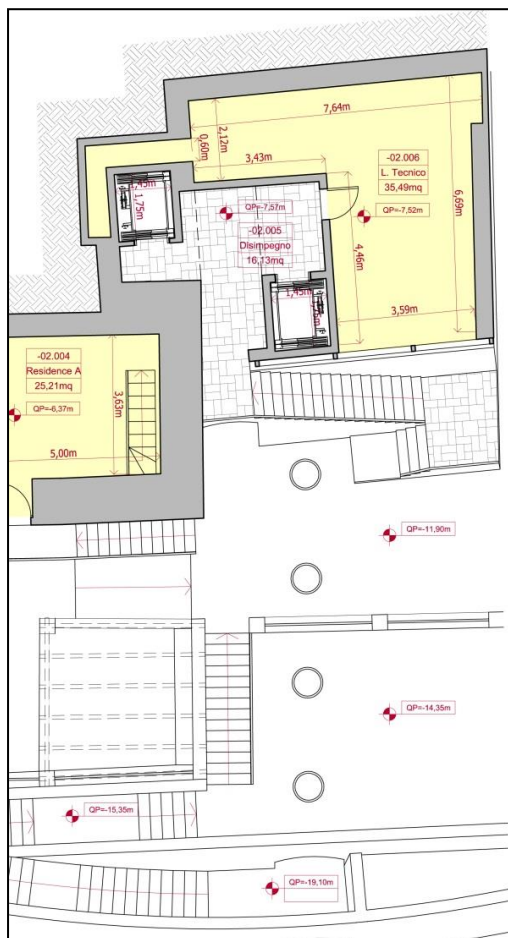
Progetto Definitivo: Stralcio pianta q.-6.52
